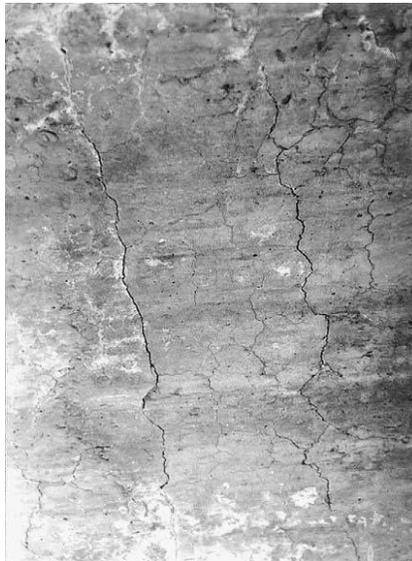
Agrietamiento superficial en el concreto (Ryall, 2001)
